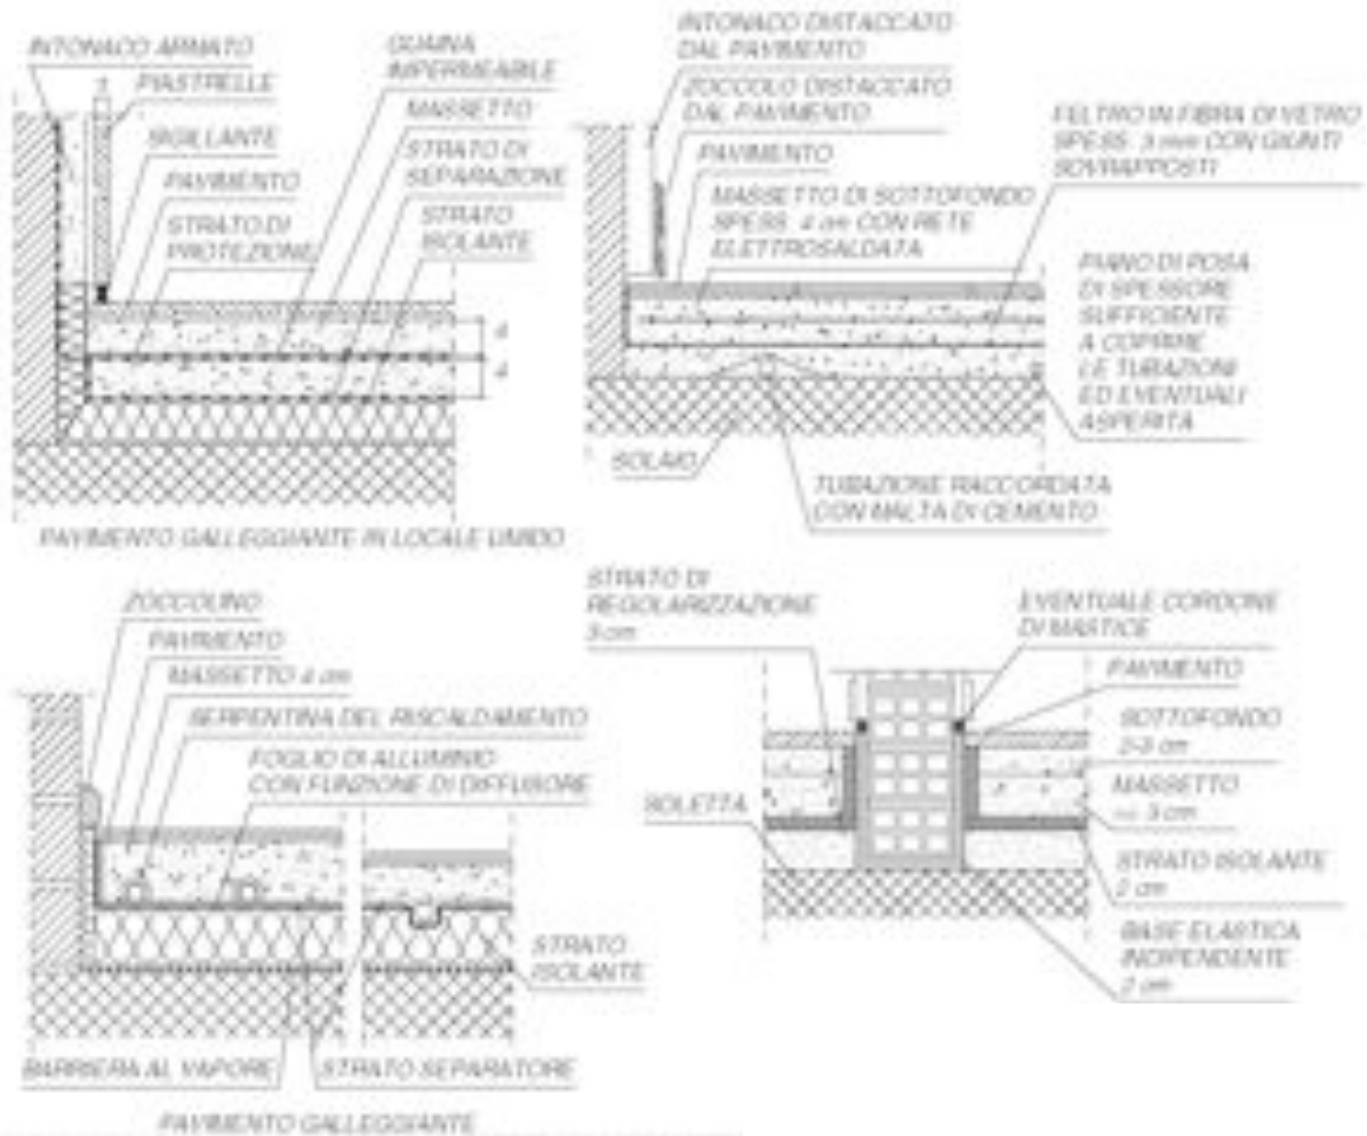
/4 PAVIMENTO GALLEGGIANTE DETTAGLI COSTRUTTIVI
